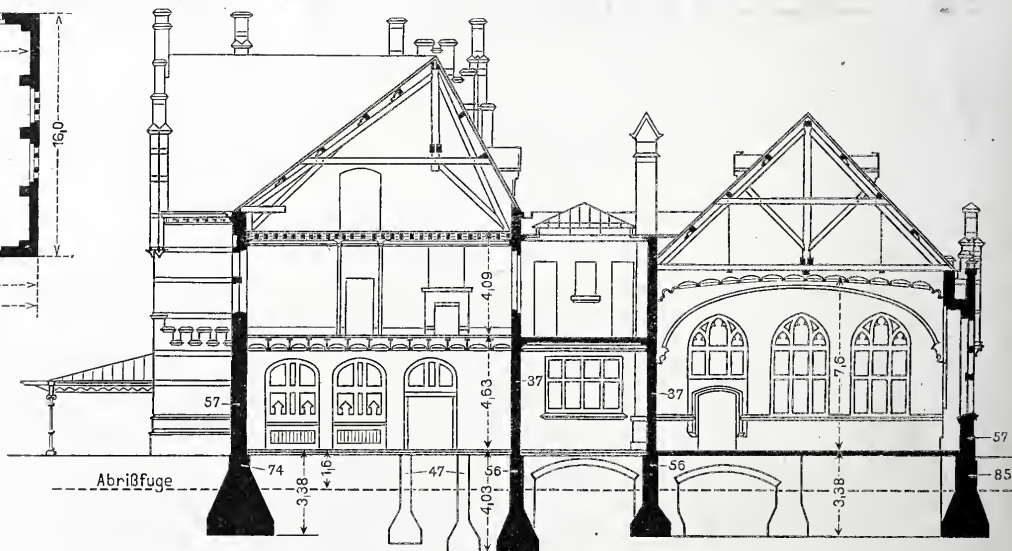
Längenschnitt mit dem alten Grundmauerwerk.
